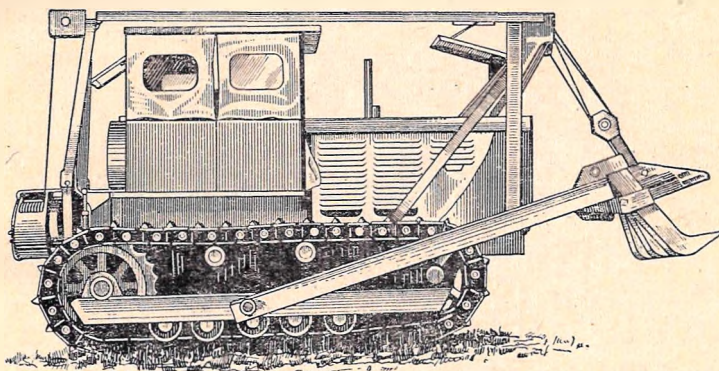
Корчеватель Д-210В: 1 — канатный подъемник; 2 — решетка; 3 — толкающие стержни; 4 — лебедка.
